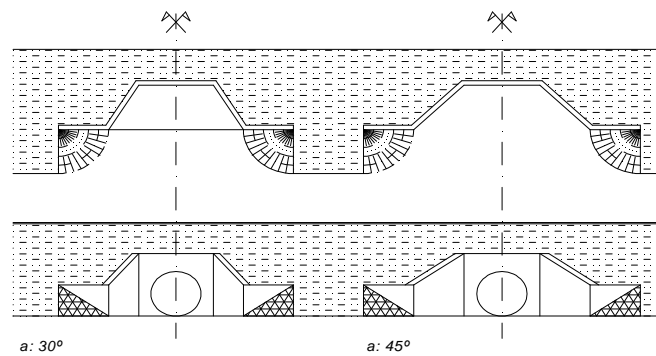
MUROS DE ALAS CON ALETAS
